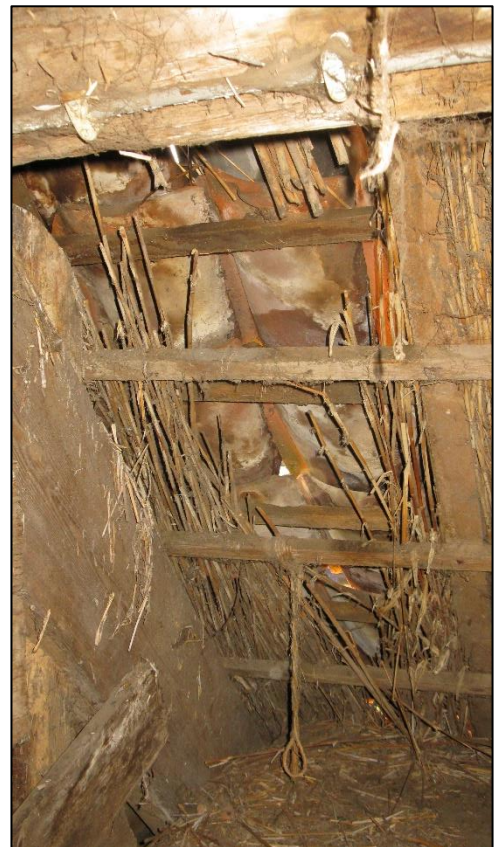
Ruimte voor vleermuizen tussen riet of tussen riet en dakpannen
